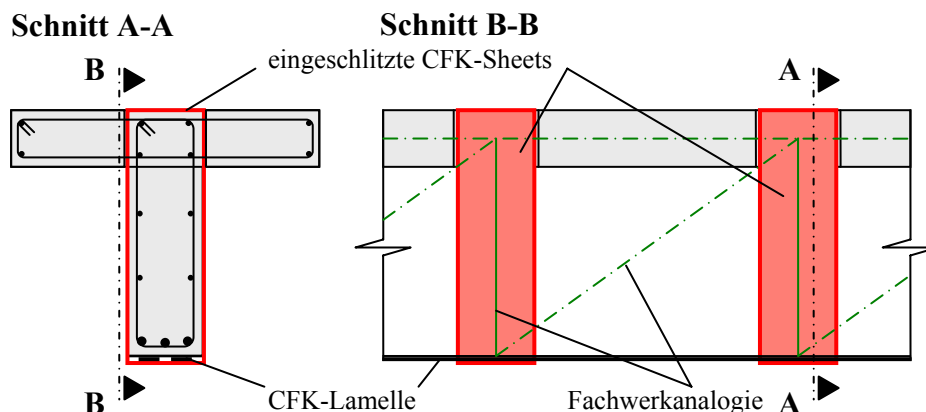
Bügelverstärkung mit CFK-Sheets (schematisch)
